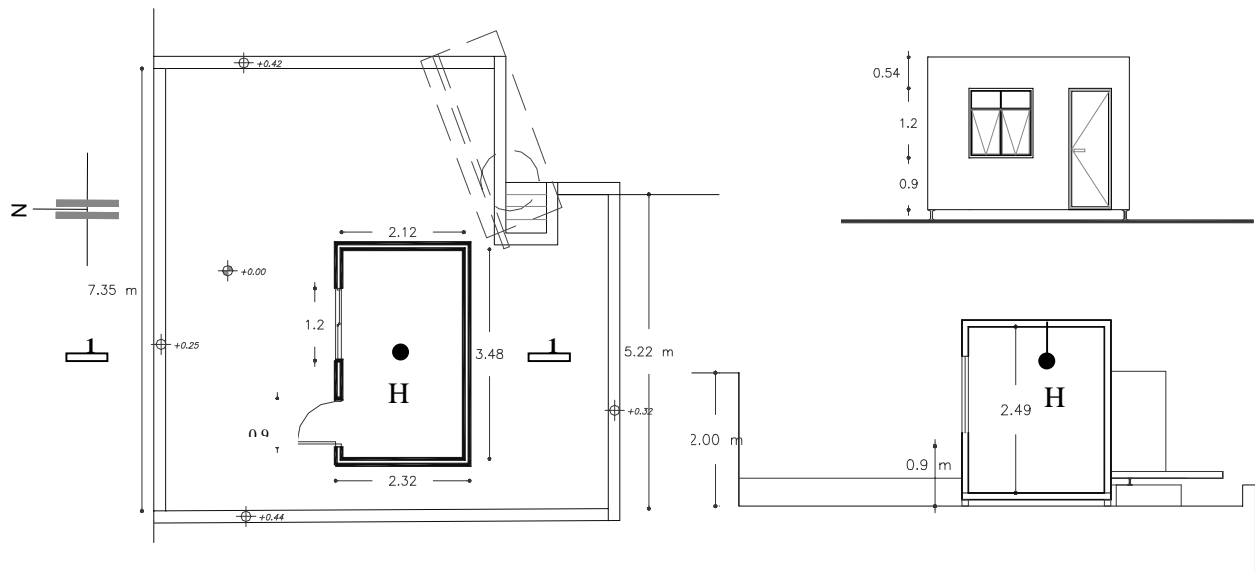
Planta, fachada norte y corte del prototipo y ubicación de los adquirentes de datos interior (H)
